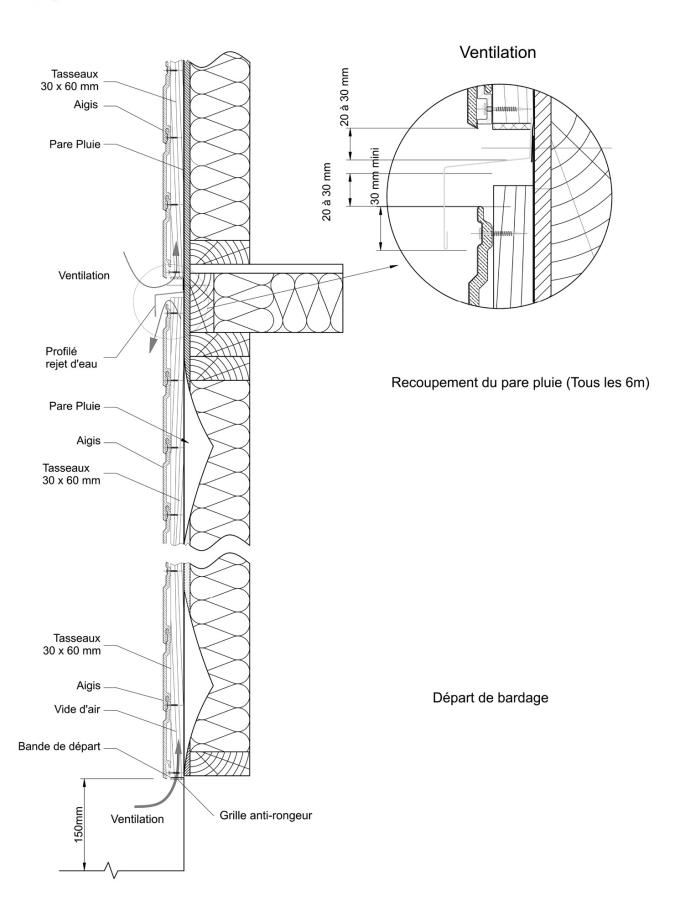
Coupe verticale sur COB et recoupement du pare-pluie
